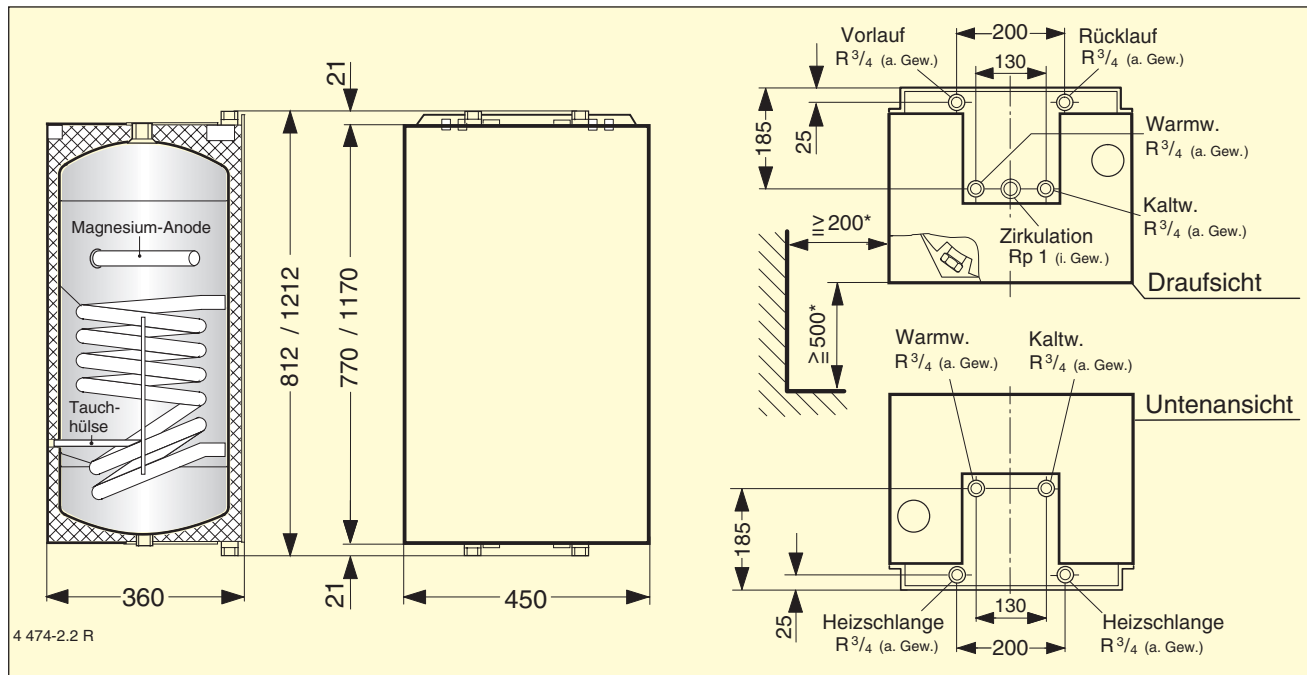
Maßangaben hinter einem Schrägstrich beziehen sich auf die nächstgrößere Speicherausführung
